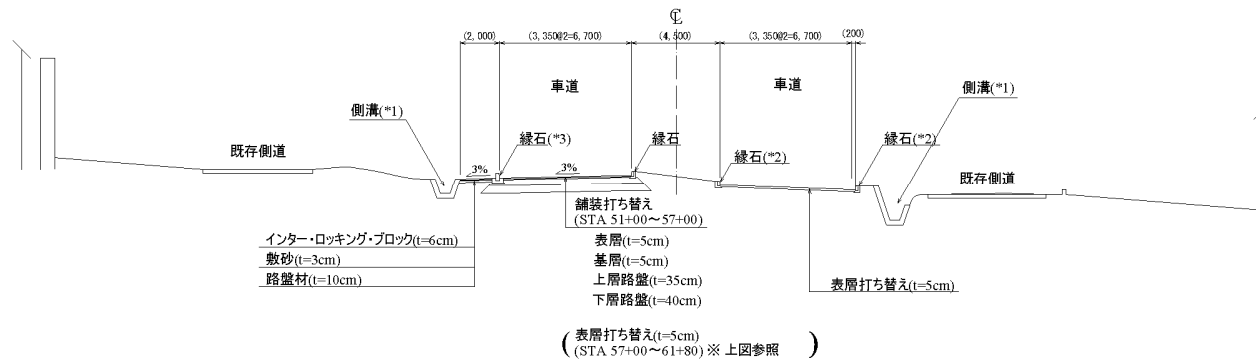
区間-3 (マセレマ RA~ヤナキス RA 区間) 標準断面図
